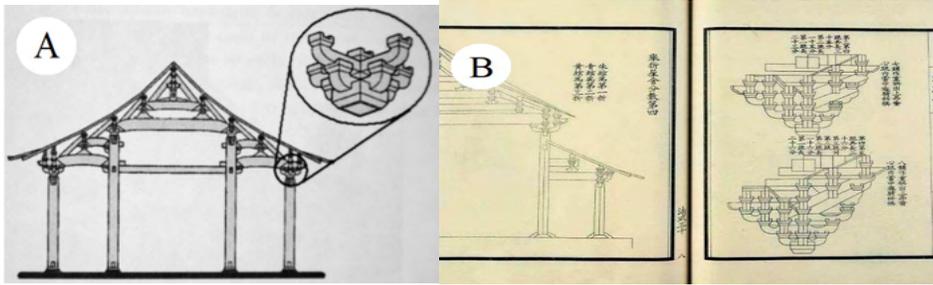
Arquitetura chinesa em madeira. Legenda: A - seção transversal de estrutura em madeira e detalhe de ensabladura. B - Modelo de tratados e manuais para ensabladuras *Yingzao Fashi*, ca. 1100 na China e *Shyomei* ca. 1605 no Japão. Fonte: (HE; et al., 2013)
